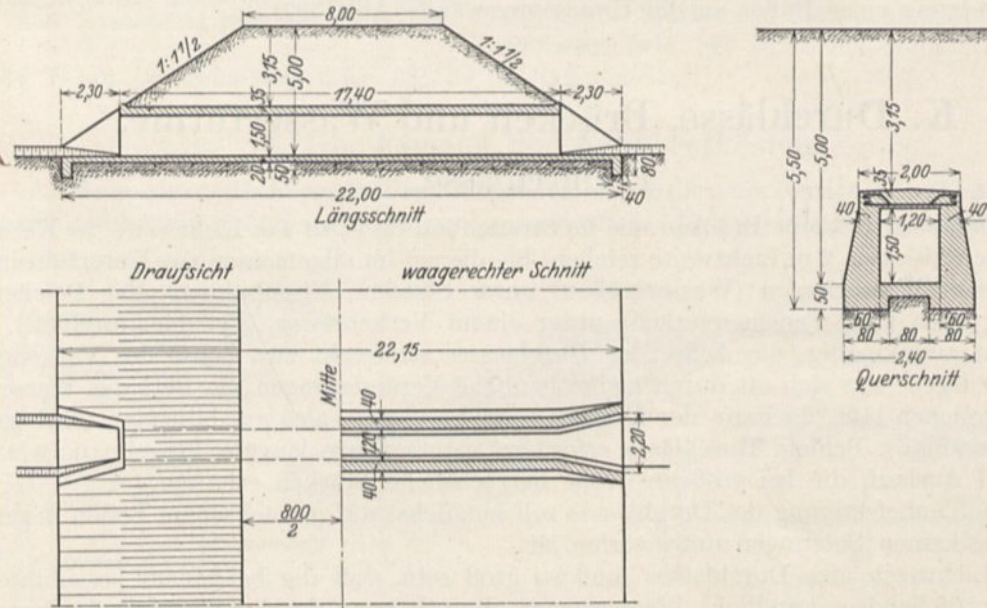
Plattendurchlaß mit Eisenbetonplatte der Chaussee Wissulke-Seegenfelde. (Ausführung: Windschild & Langelott A.-G., Berlin.)
